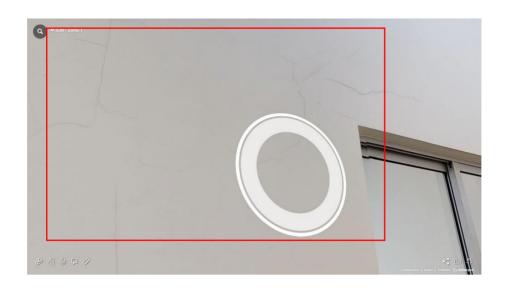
Pasillo 1 (Fisura en columna)
